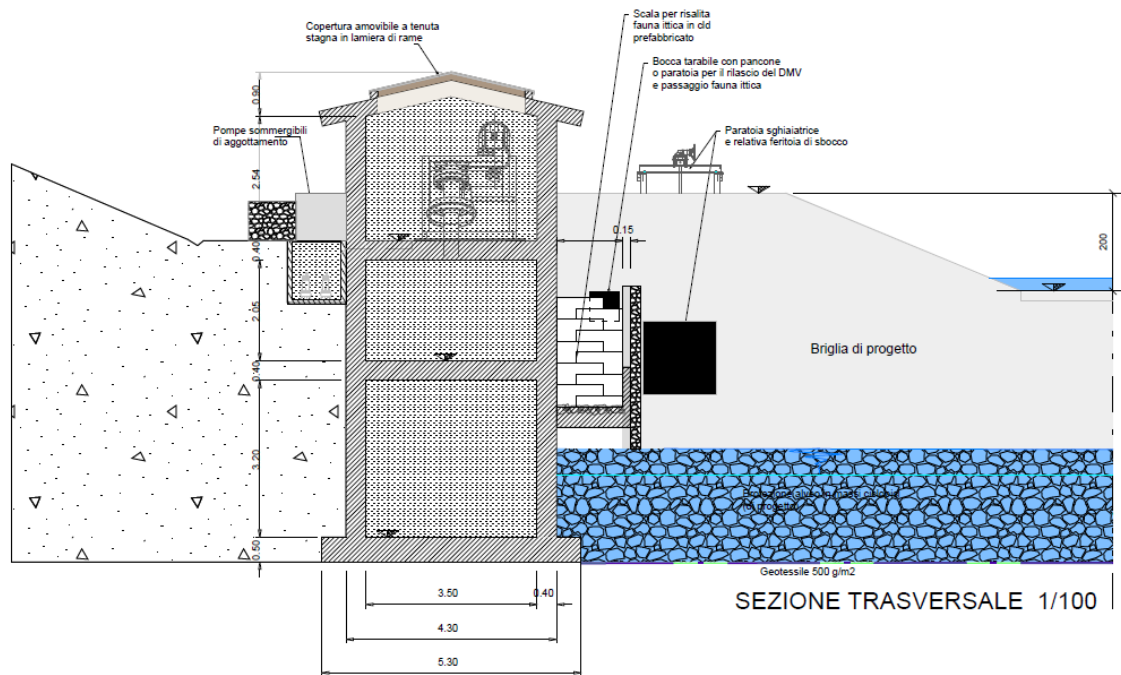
Sezione di progetto del manufatto e delle opere accessorie
